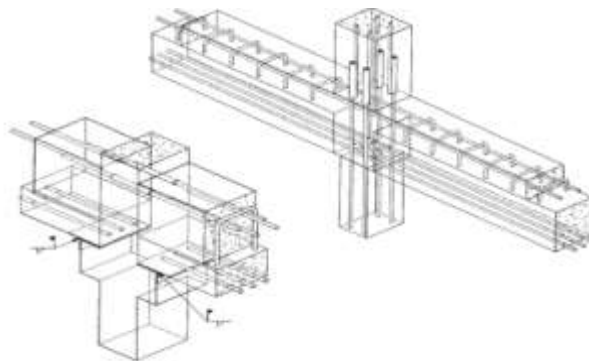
Sambungan Balok Induk dan Balok Anak
